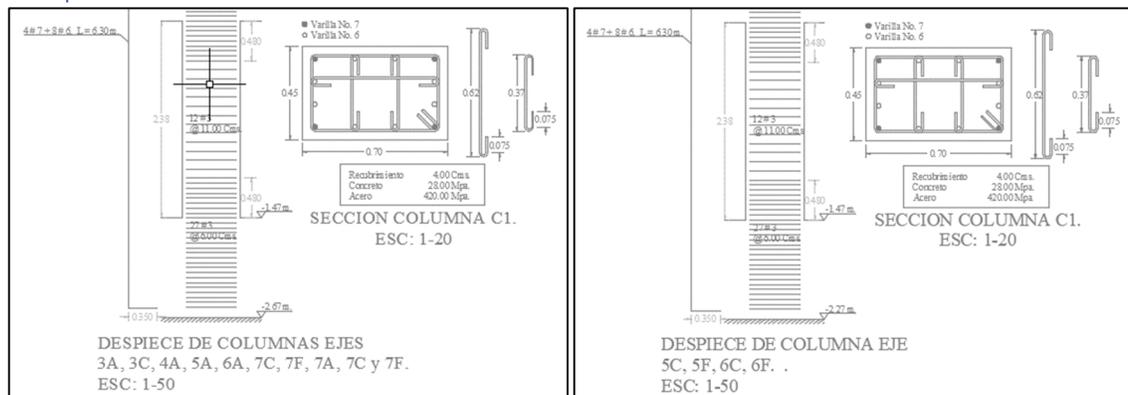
, Despiece de columnas ejes 5A, 5C, 5F, 6A, 6C, 6F, Fuente: Constructora Open House.
